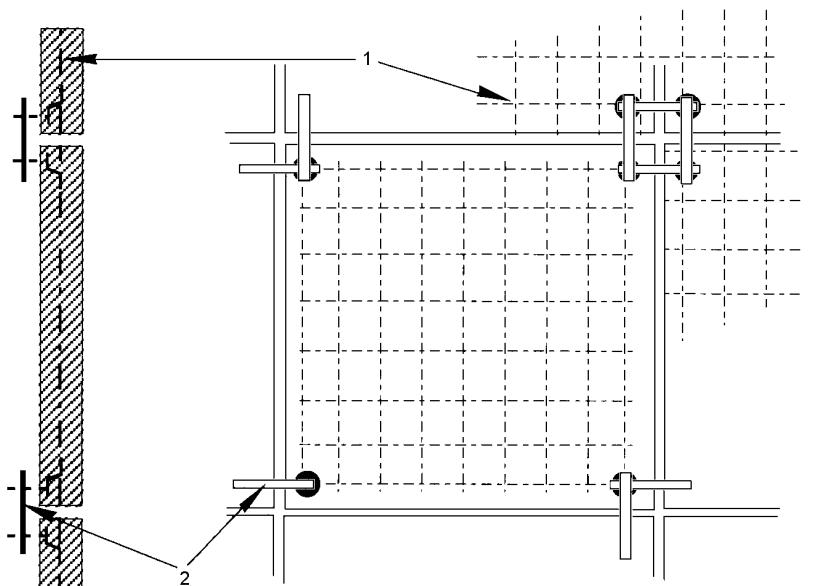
Installation de conducteurs d'équipotentialité sur des panneaux préfabriqués en béton armé au moyen de connexions à écrous ou soudées
